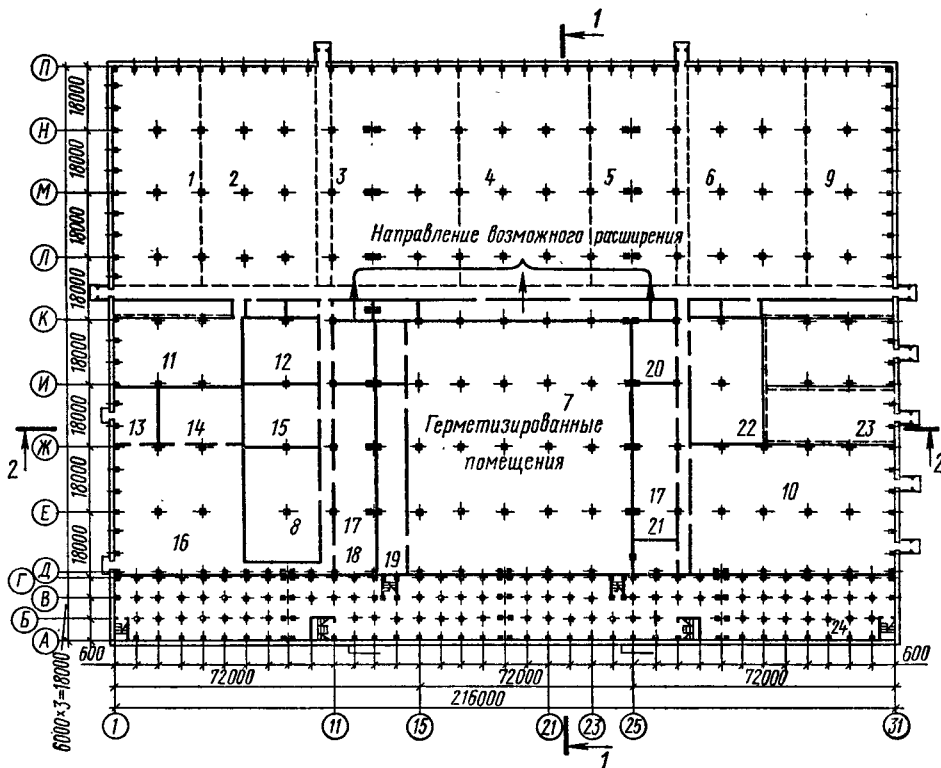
План одноэтажного универсального здания с герметизированными помещениями для изготовления точных приборов:
